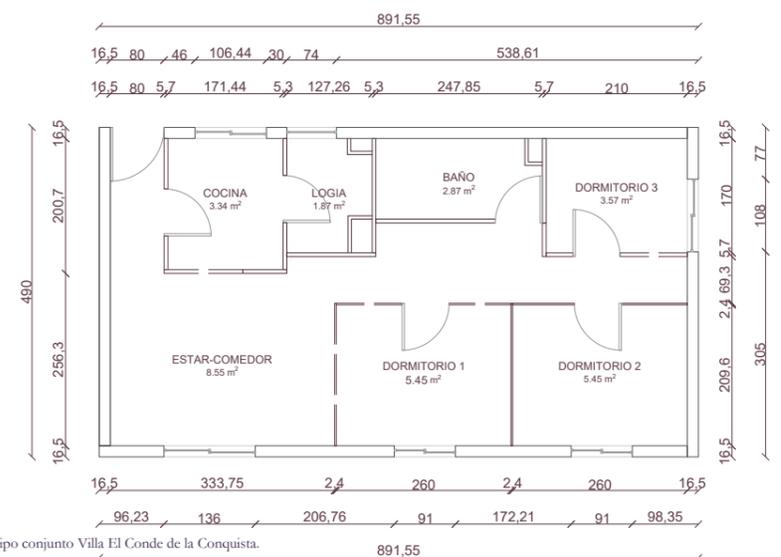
Planta departamento tipo conjunto Villa El Conde de la Conquista. Elaboración propia en base al material entregado por la DOM.
